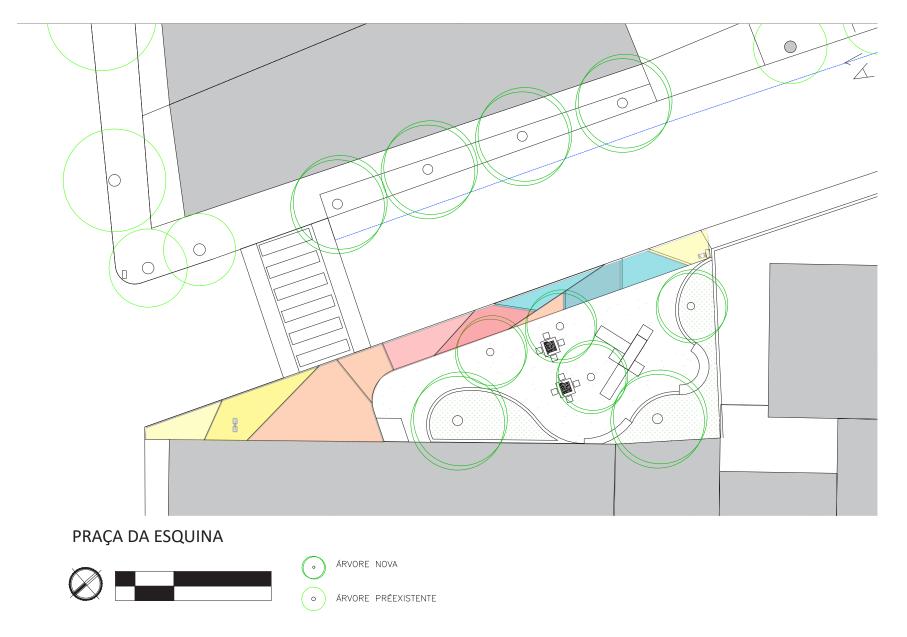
Planta do estudo preliminar para a praça da esquina Fonte: Autor, 2025.
